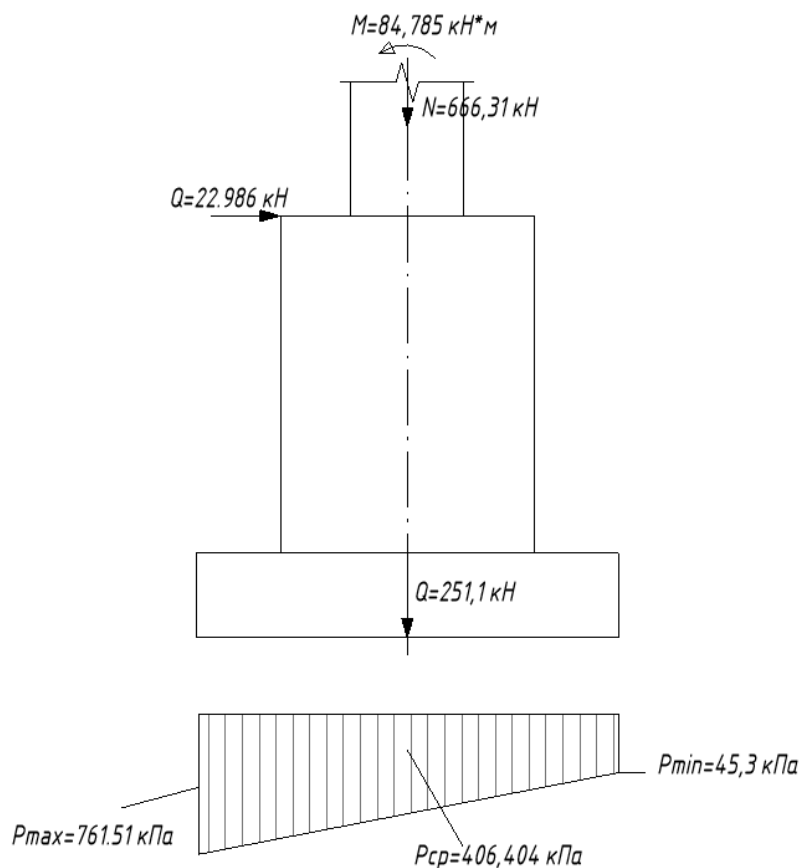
Эпюра давлений под подошвой фундамента
